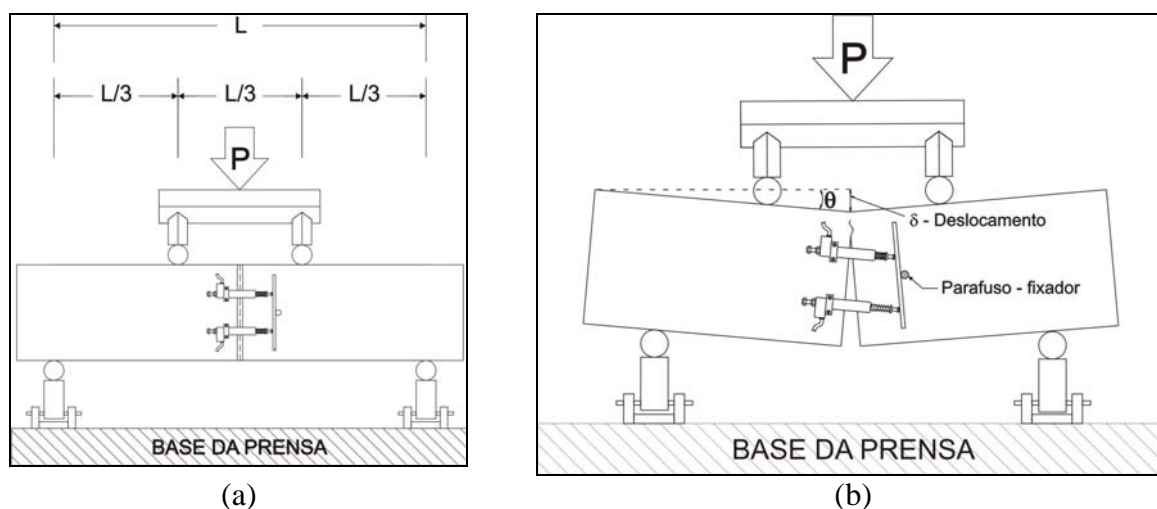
Esquema do ensaio de flexão a quatro pontos de vigas (a) configuração do ensaio; (b) movimento de corpo rígido da viga durante o ensaio.
